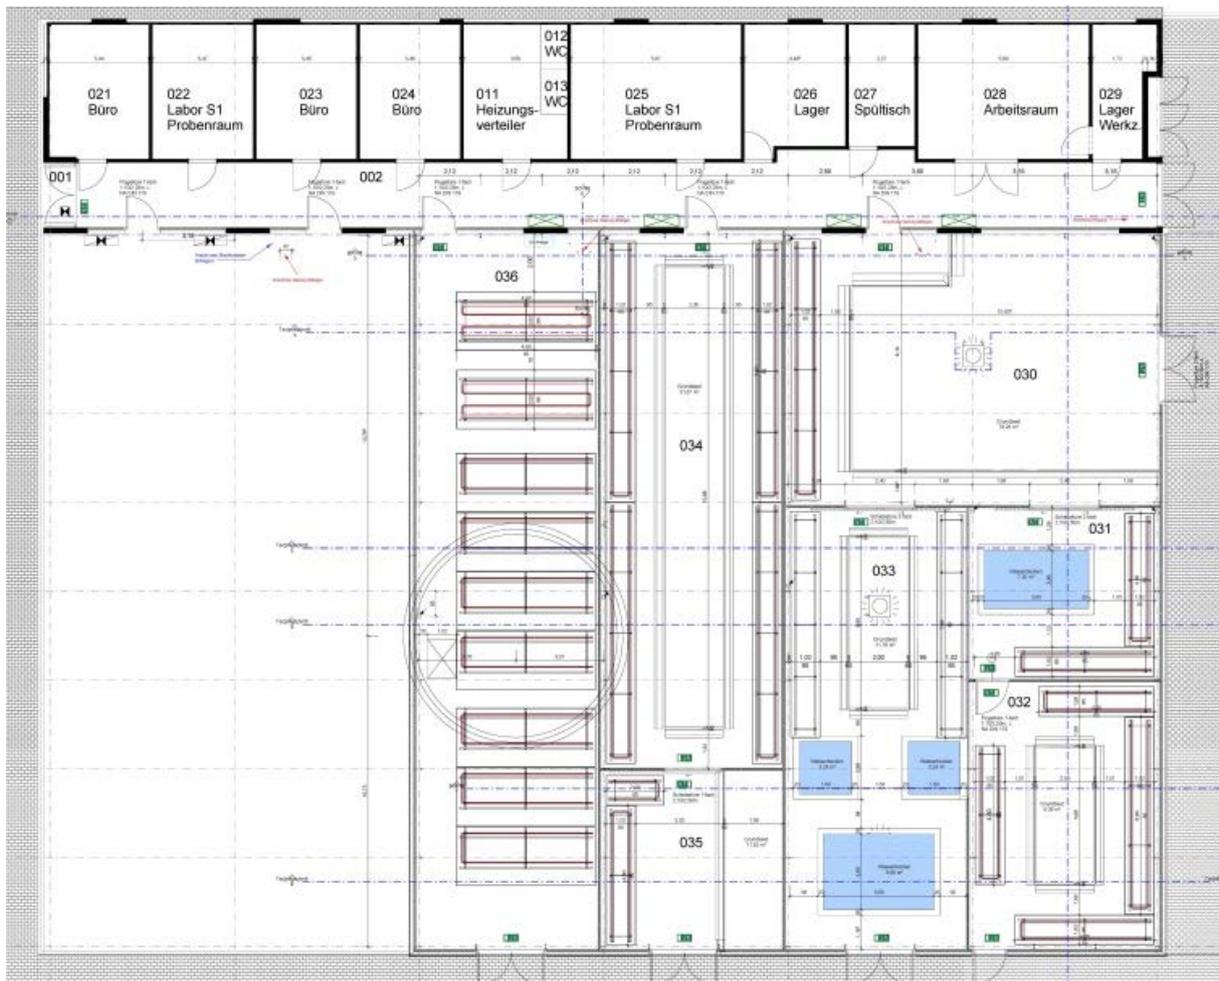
Grundriss Neues Sammlungsgewächshaus
